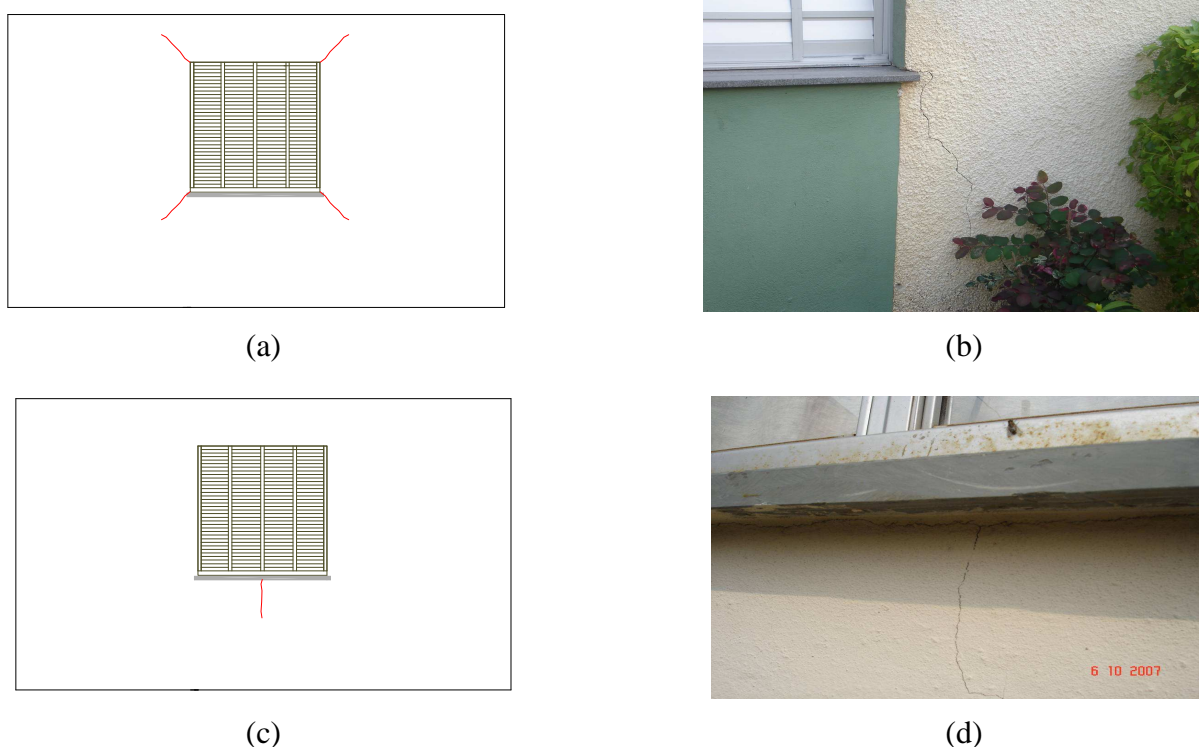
(a) configuração típica de fissuras inclinadas nos vértices do vão da esquadria; (b) caso de fissura inclinada no vértice inferior do vão da esquadria; (c) configuração típica de fissura vertical sob o peitoril; (d) caso de fissura vertical sob o peitoril.
